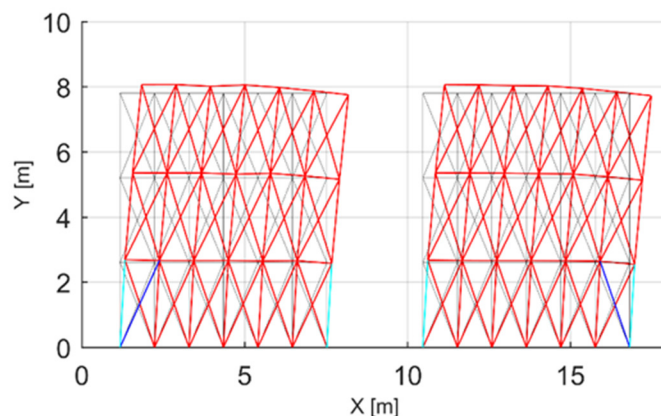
Zoom deformada final modelo MA, edificio con muros rectangulares.
